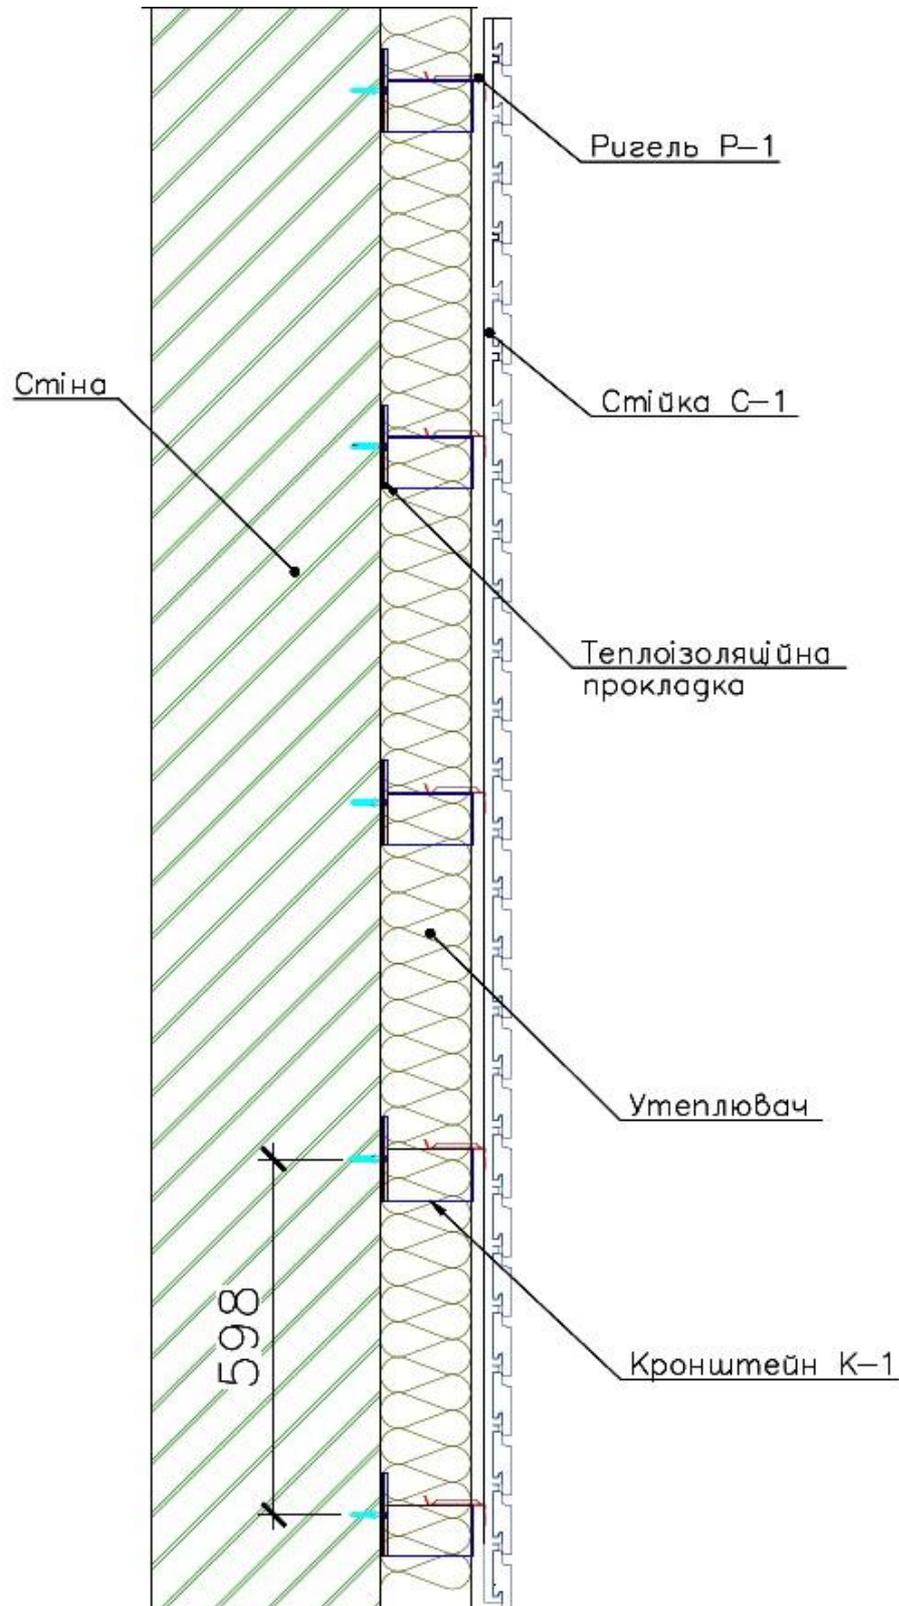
Схематичне зображення перерізу стіни з системою фасадного утеплення
